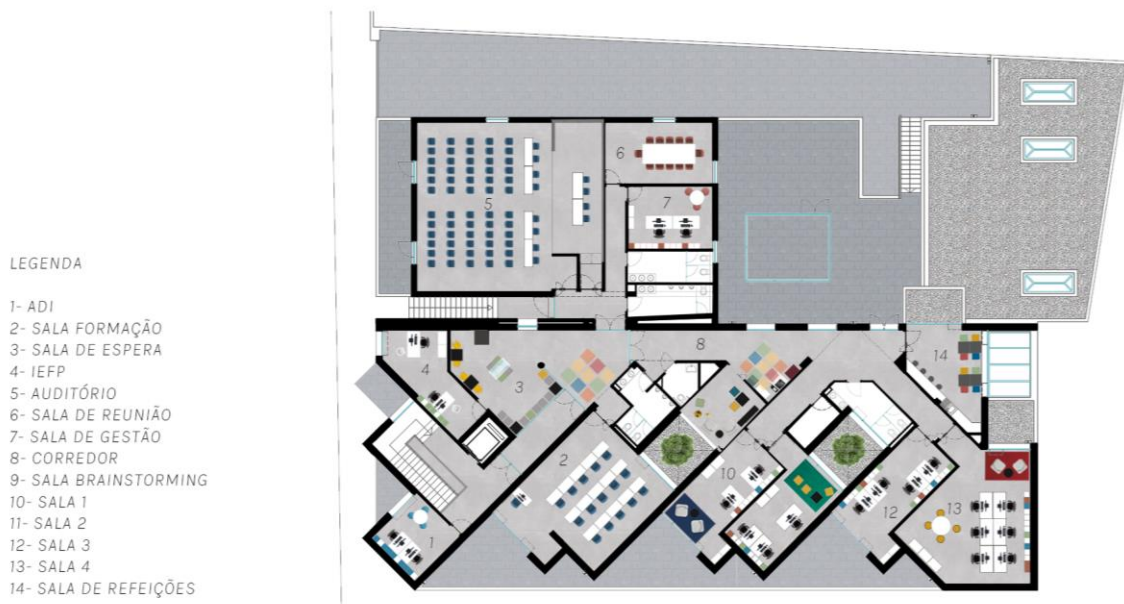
Planta humanizada, piso 1. Fonte: FBN.
